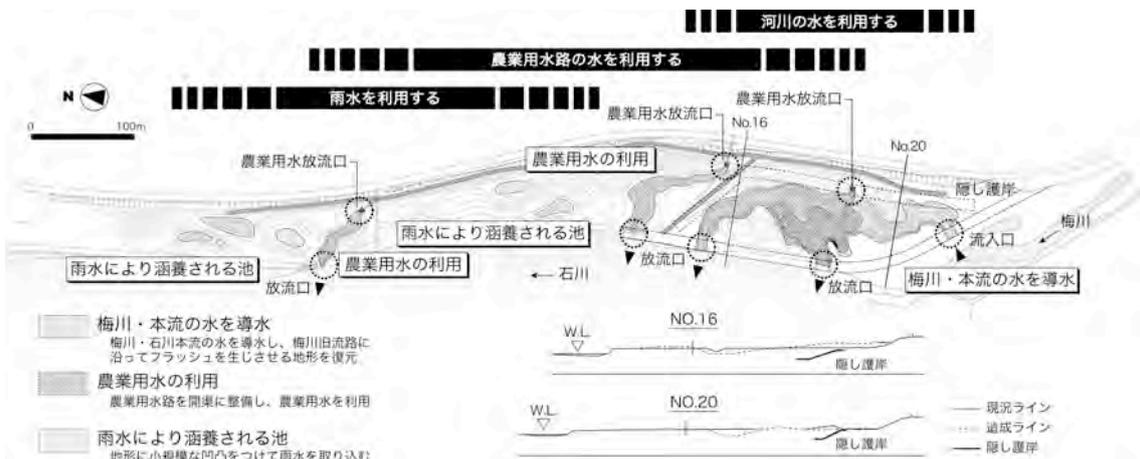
A 地区のゾーニングと計画平面図^{注 4.2)}
